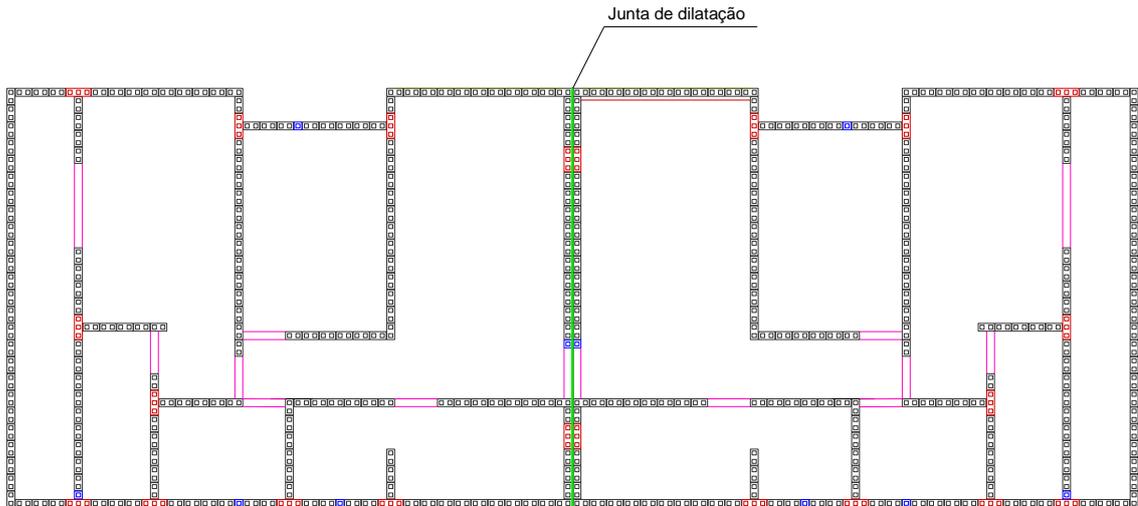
Indicação da junta de dilatação no projeto estrutural.
